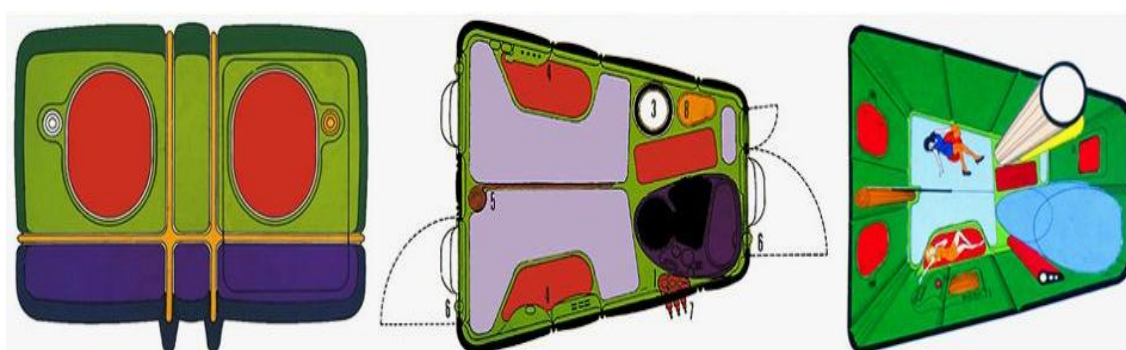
Alçado Frontal, Planta Genérica e Perspetiva da *Plug-In Capsule
